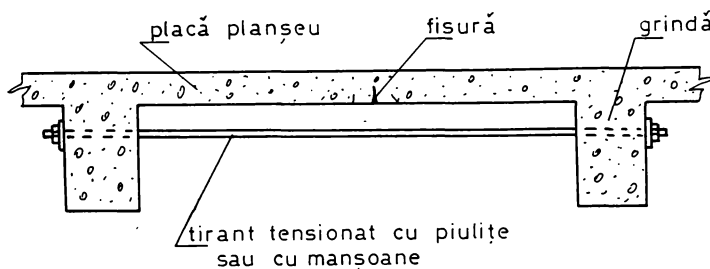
Remedierea fisurilor la o placă de planșeu cu ajutorul tiranților
